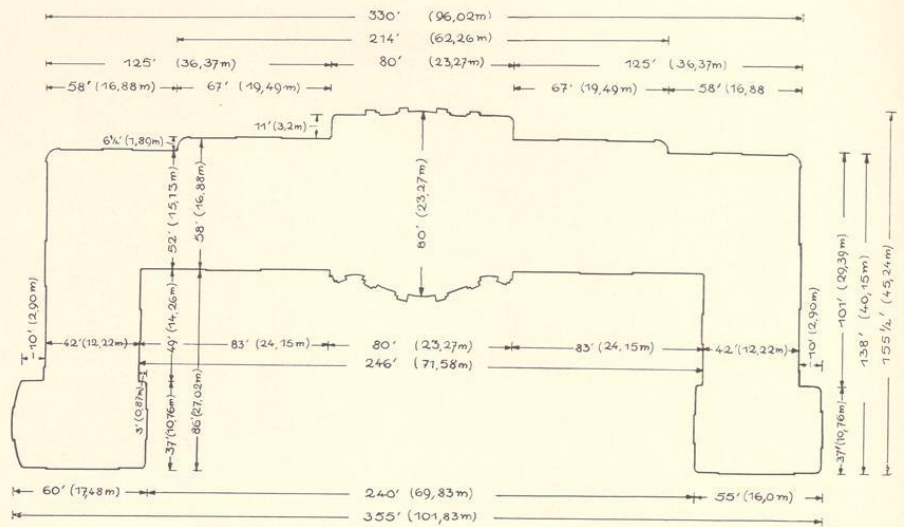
Grundriß des Schlosses nach dem Plan von 1768 mit eingeschriebenen Maßen nach münsterschem Fuß und Meter
